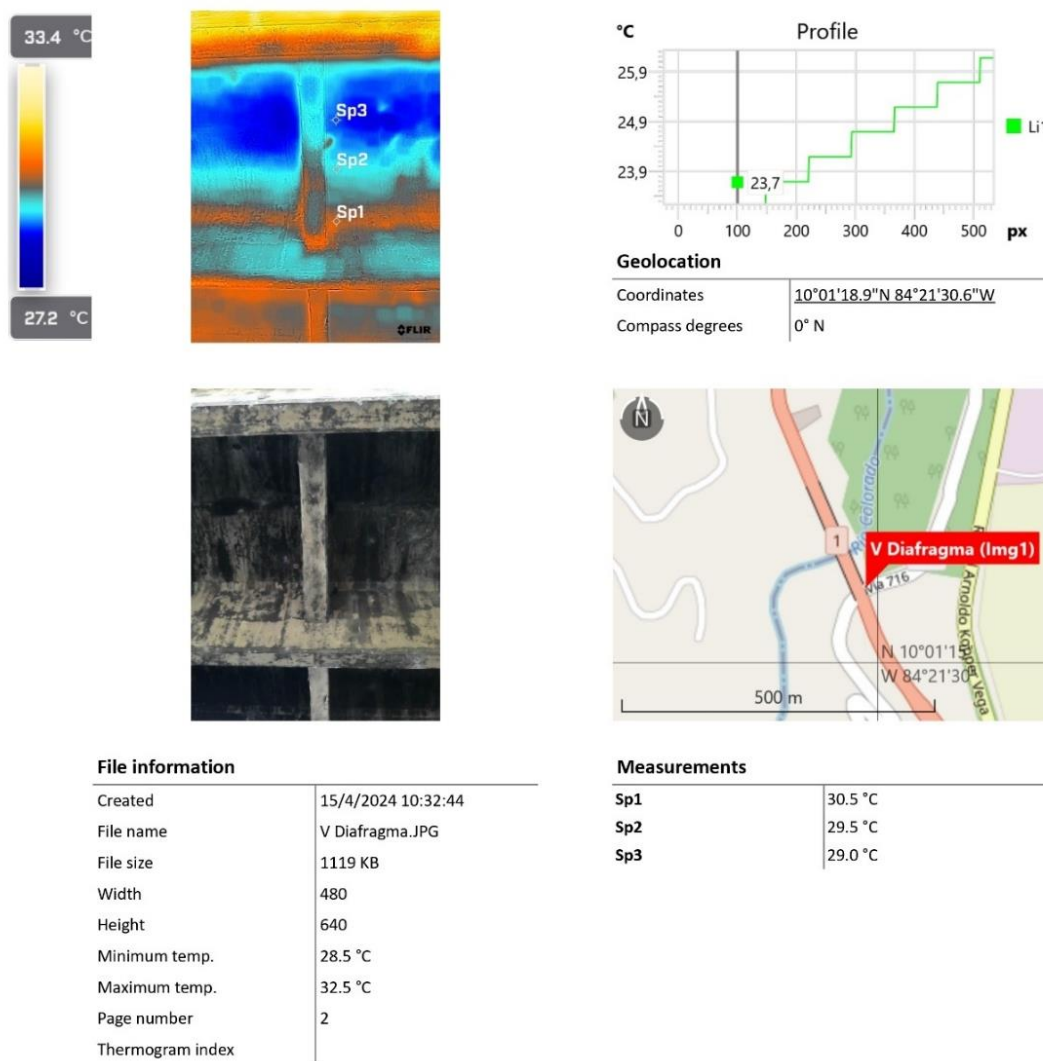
22 Reporte de descascaramiento en la viga diafragma de la sección No. 3
